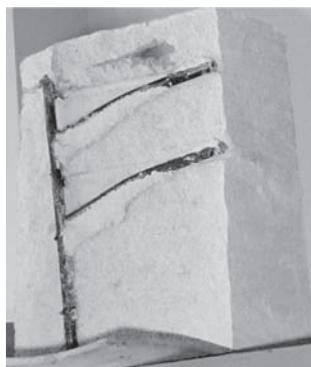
Смятие ячеистого бетона под анкерами и деформирование поперечных анкеров в испытанных образцах
